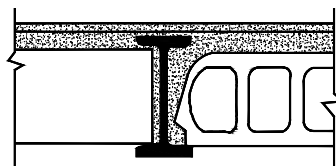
CP11. Apoyo de vigueta y bovedilla en viga de acero
